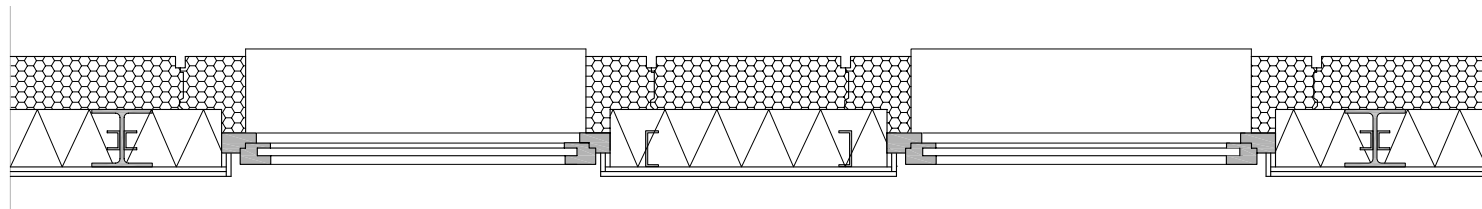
Schnitt Steildach, Aufbau 6b, M. 1:20
